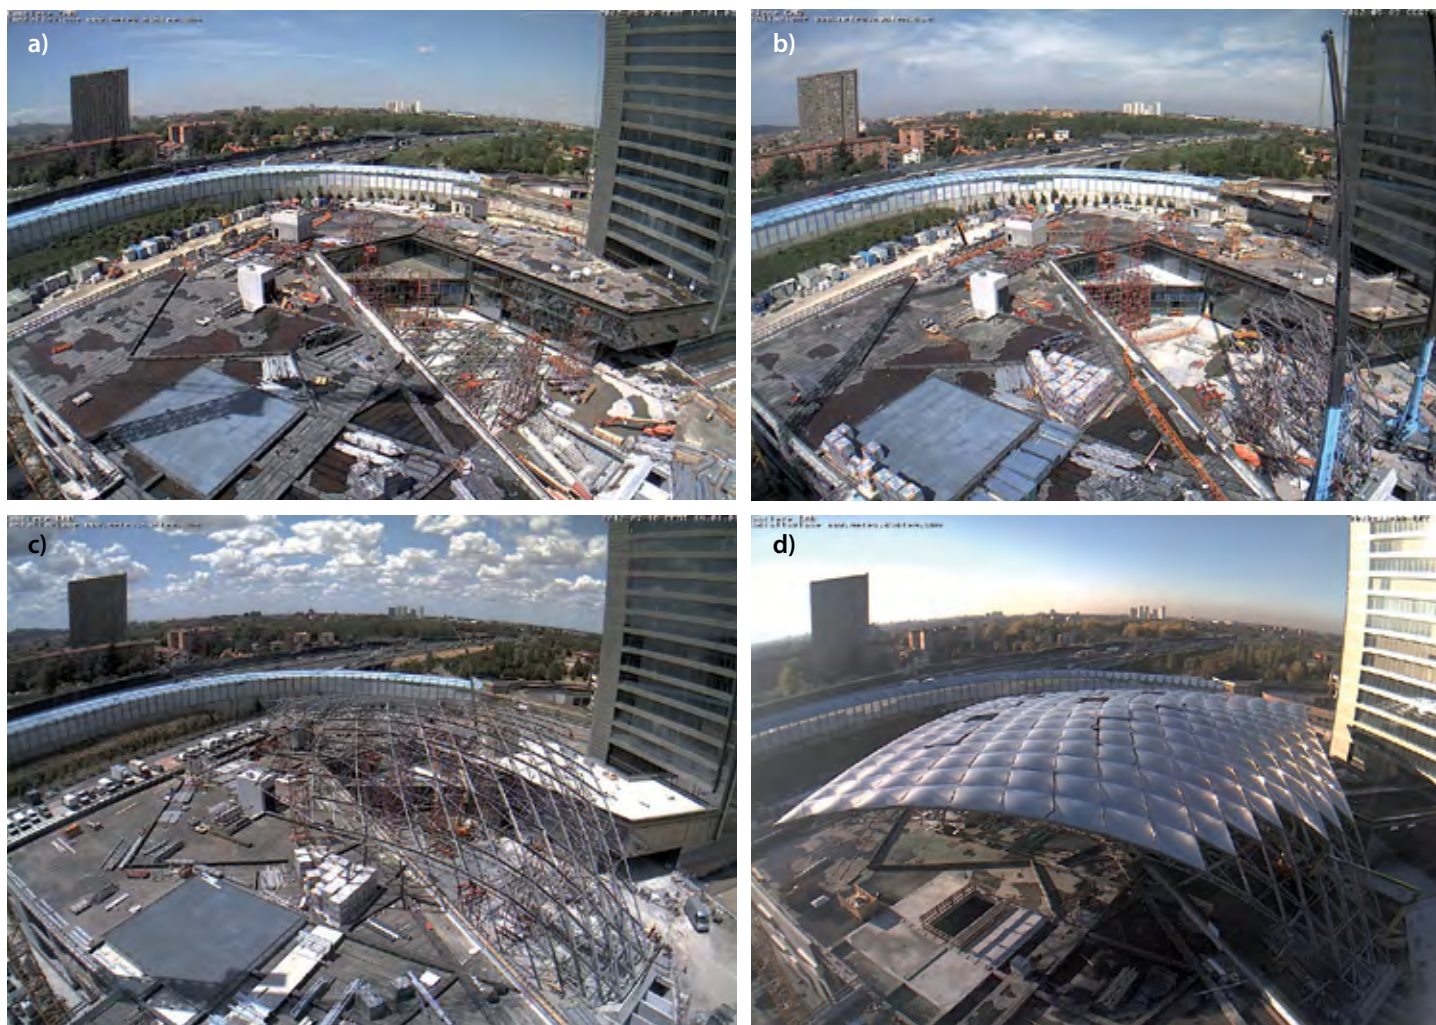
Sequenza di montaggio della struttura reticolare spaziale: a) montaggio della parte frontale della struttura a terra, b) posizionamento della parte pre assemblata a terra, c) completamento del montaggio della struttura sul piano rialzato, d) Posizionamento della copertura in cuscini di ETFE
